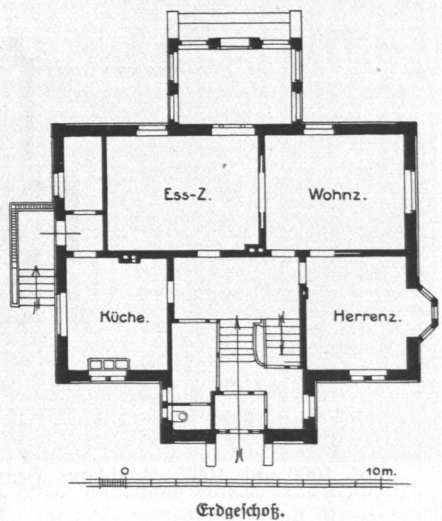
und 1095. Landhaus Baetke, Reinbek, erbaut 1910 durch Architekt Emil Neupert.
